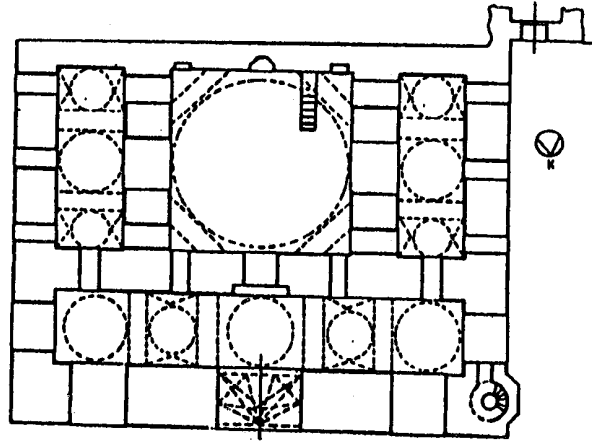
مسقط أفقي لجامع محرومة سلطان في استانبول
